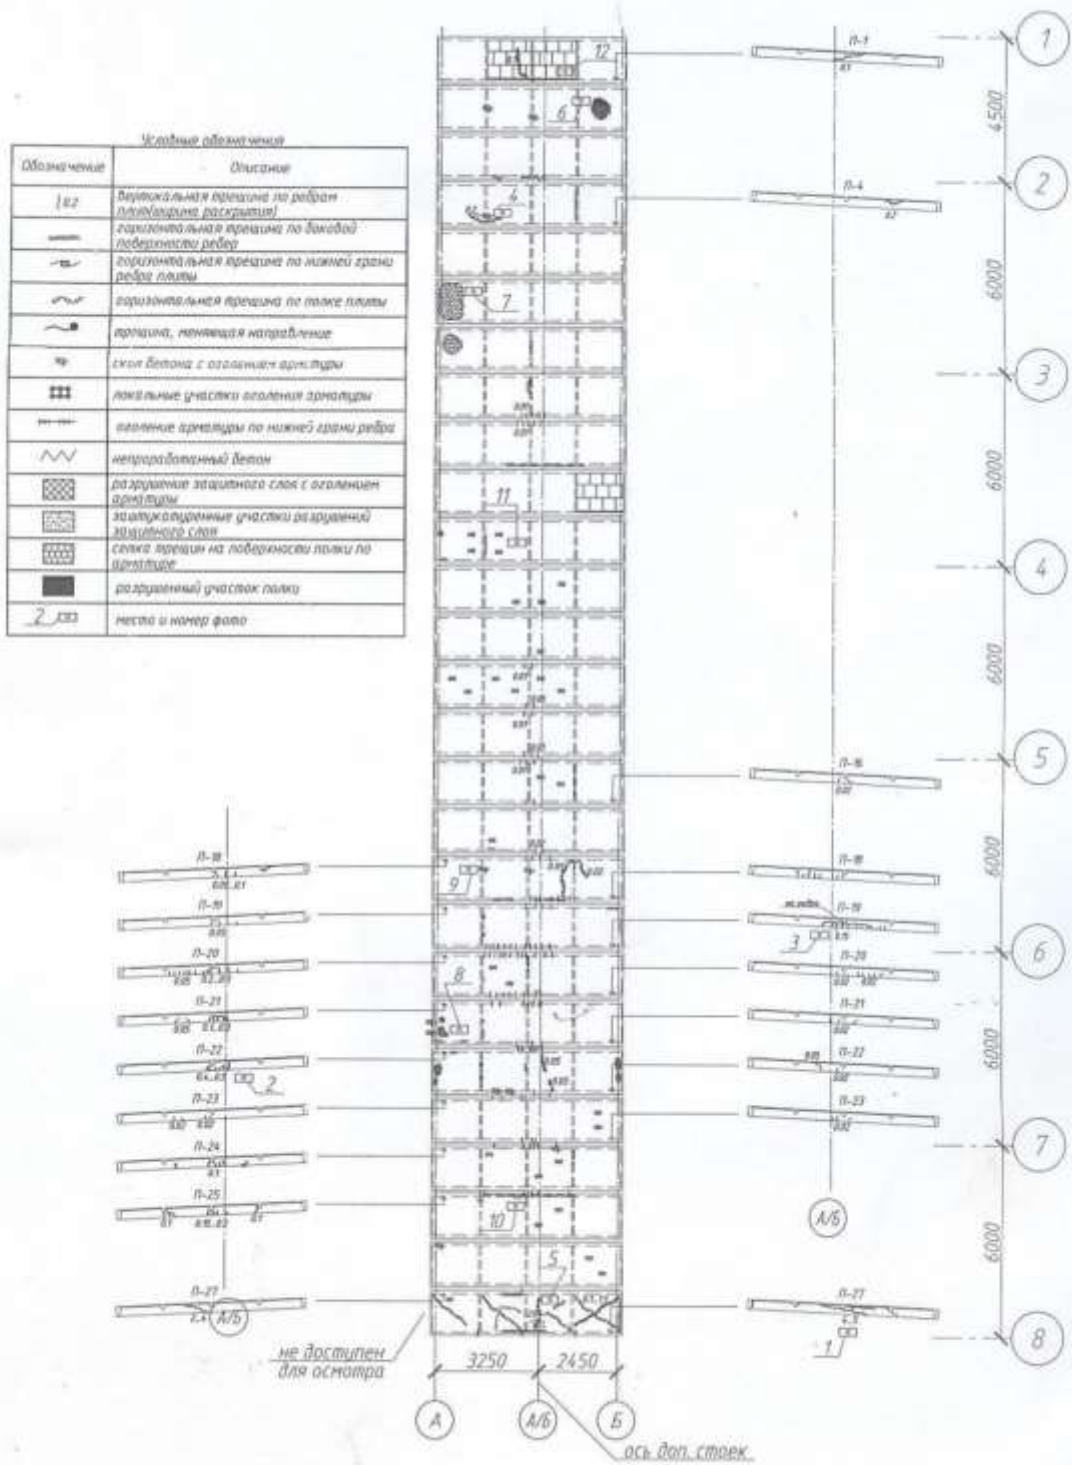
Карта дефектов и повреждений плит перекрытия
